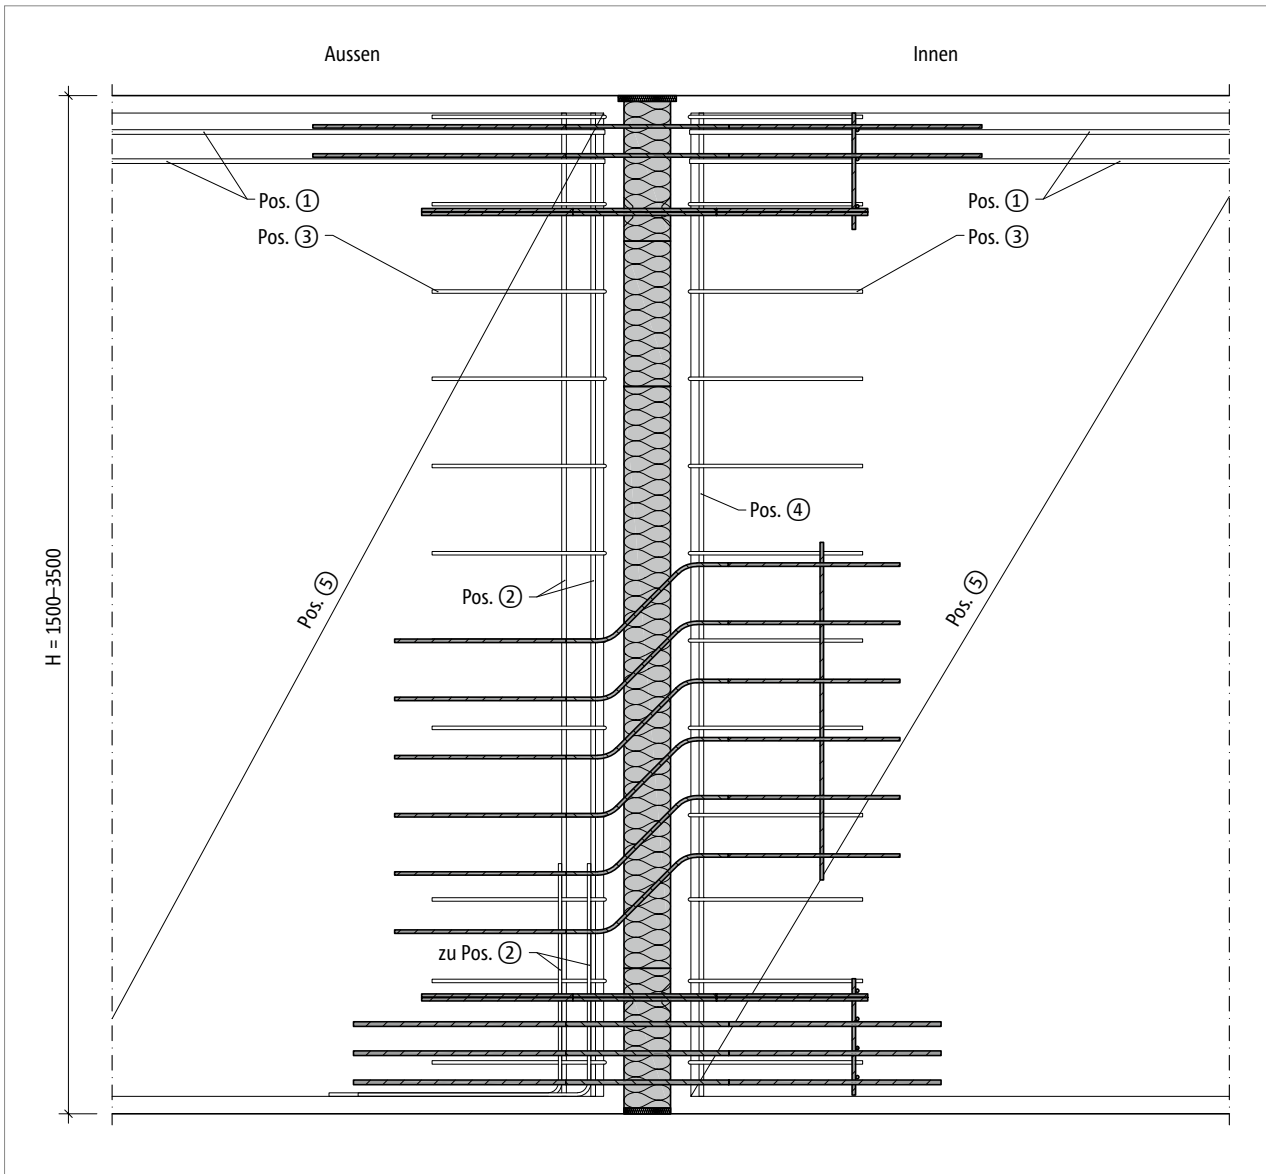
Schöck Isokorb® T Typ WL: Bauseitige Bewehrung; Schnitt
